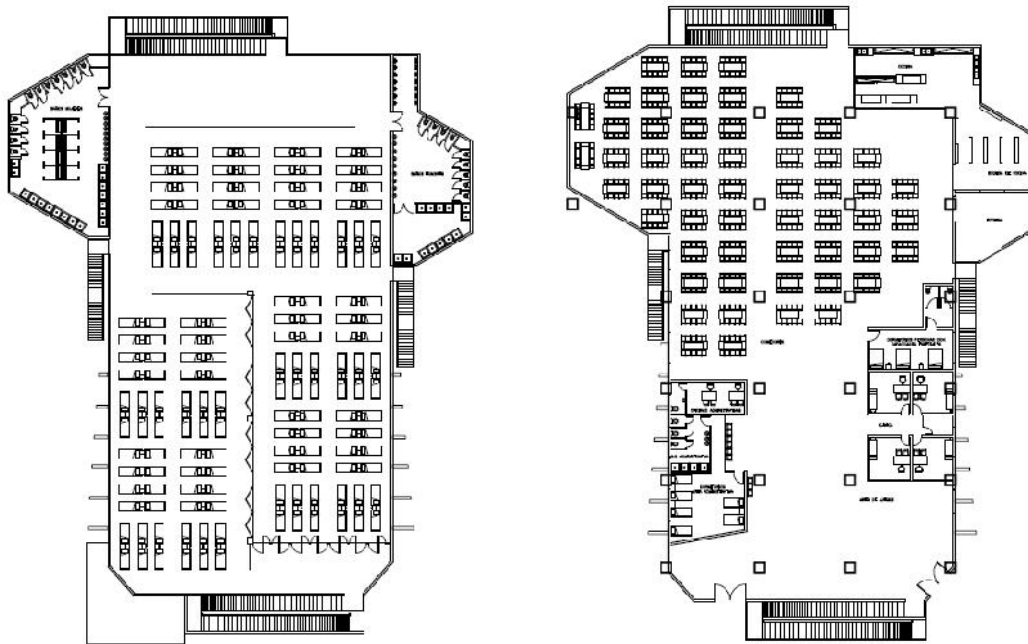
Plantas Arquitectónicas del Edificio para Albergue.
